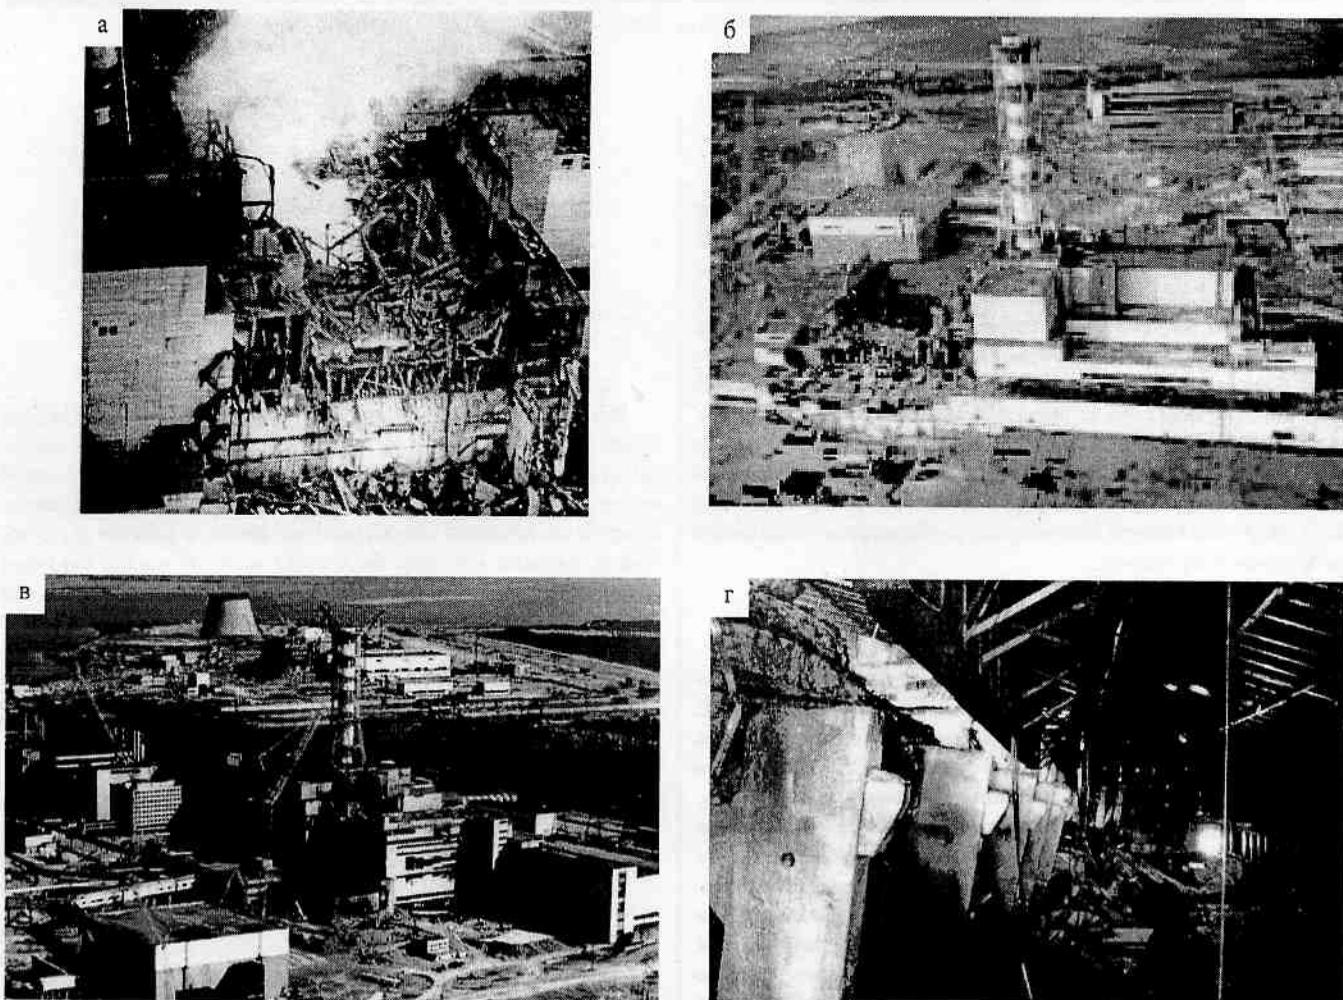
Общий вид разрушенных конструкций четвертого энергоблока ЧАЭС:
